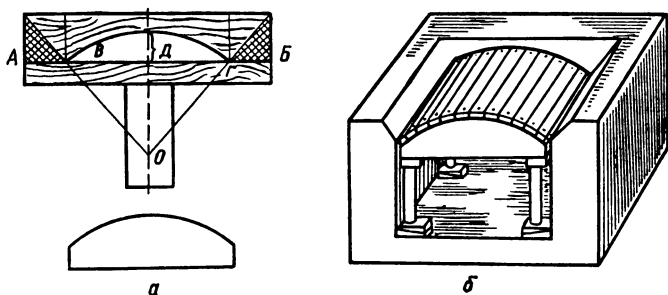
Построение кружала для свода и шаблона для пят (а); опалубка для кладки сводов (б).
